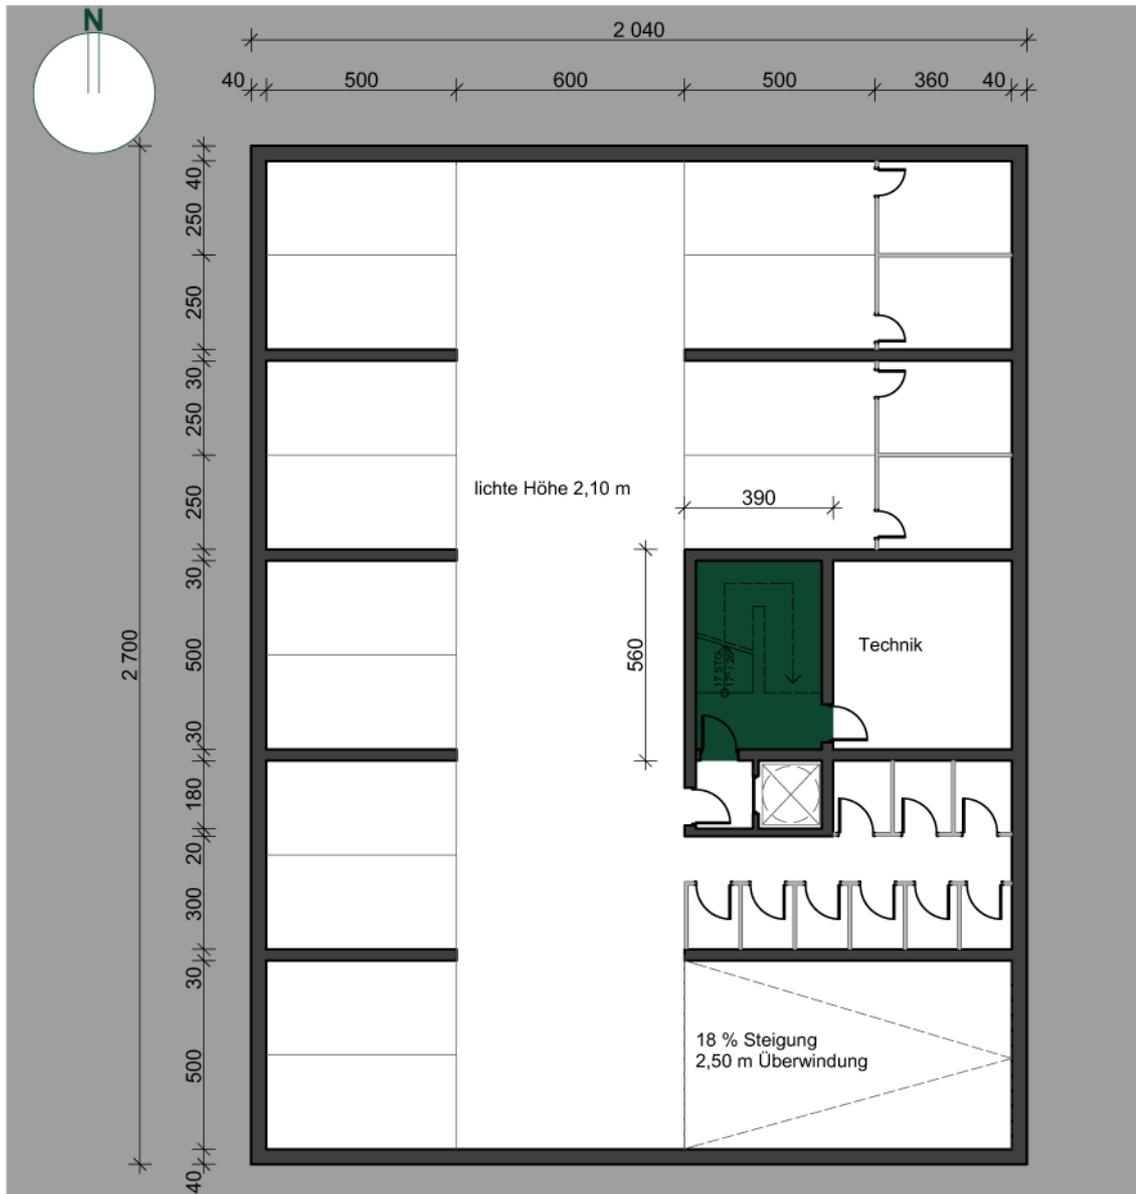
Untergeschoß, Stahlbetonkern 1:200
